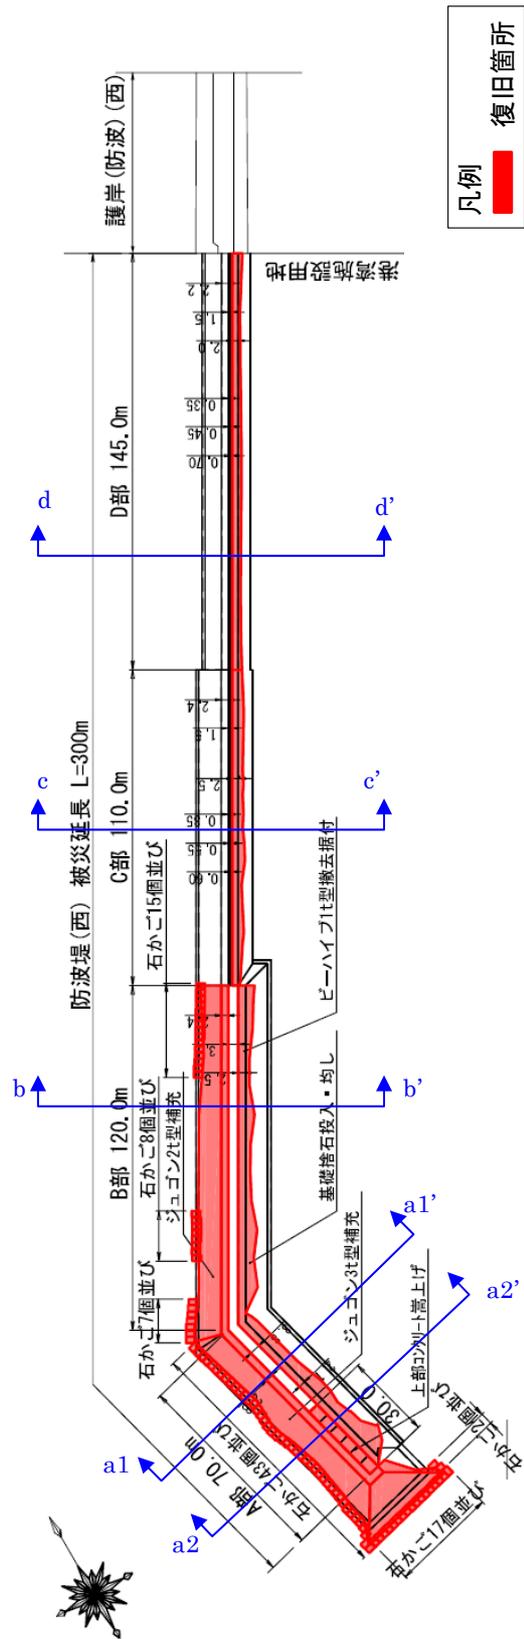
10 No. 2 防波堤(西)の平面図(復旧後)
